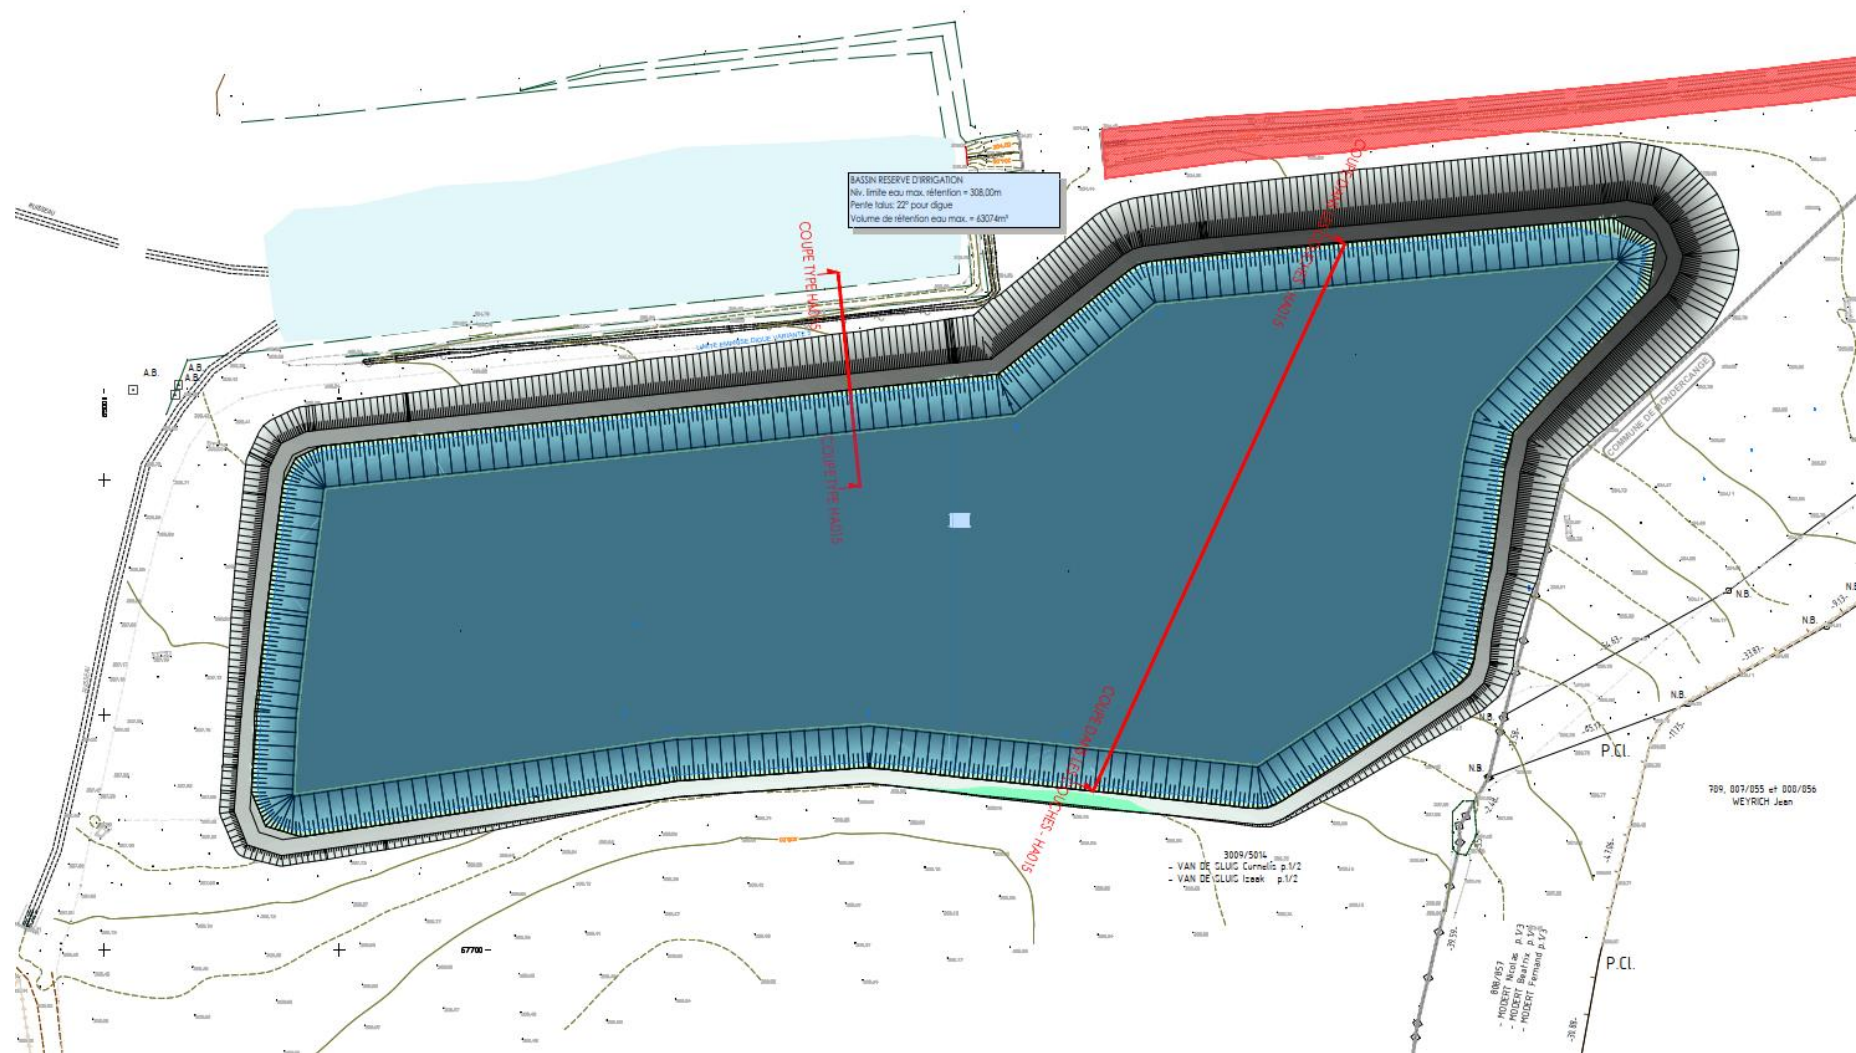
Auszug aus dem Plan „Concept du Bassin – Vue en plan et profil en long“ (LUXPLAN S.A. Stand 05/2022).
